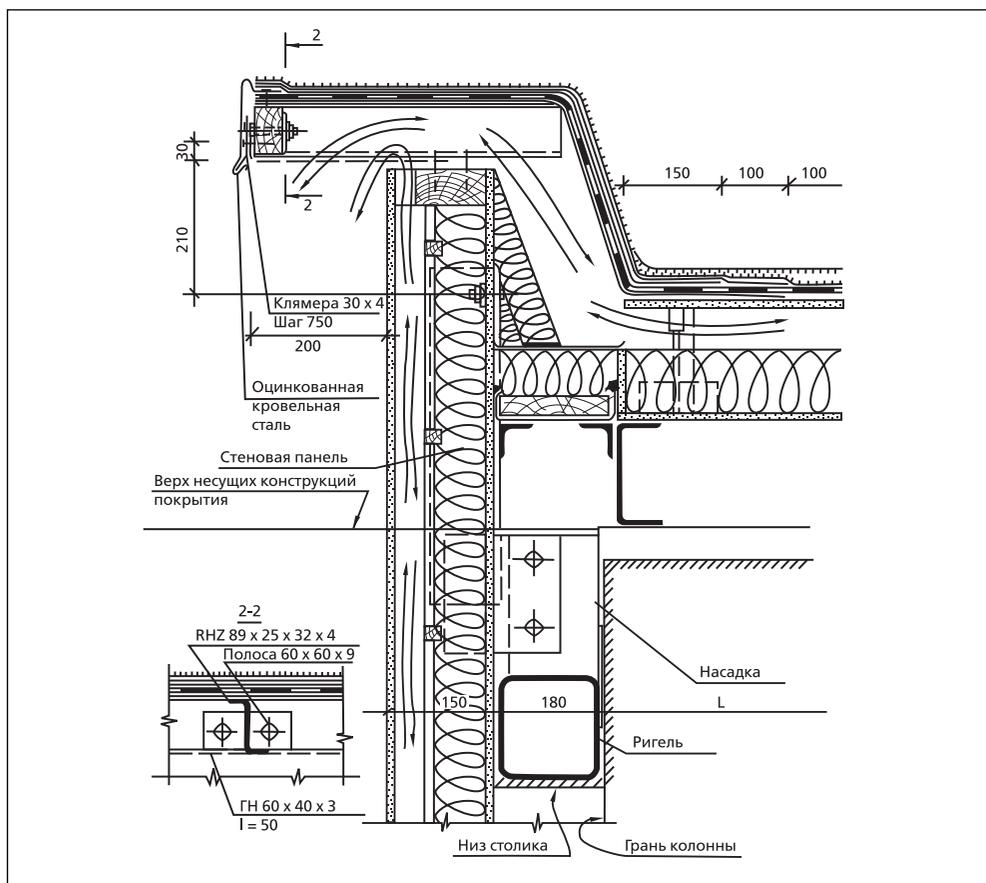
Конструкция парапета с использованием древесины, металла для вентилируемой крыши и стен из каркасных плит
